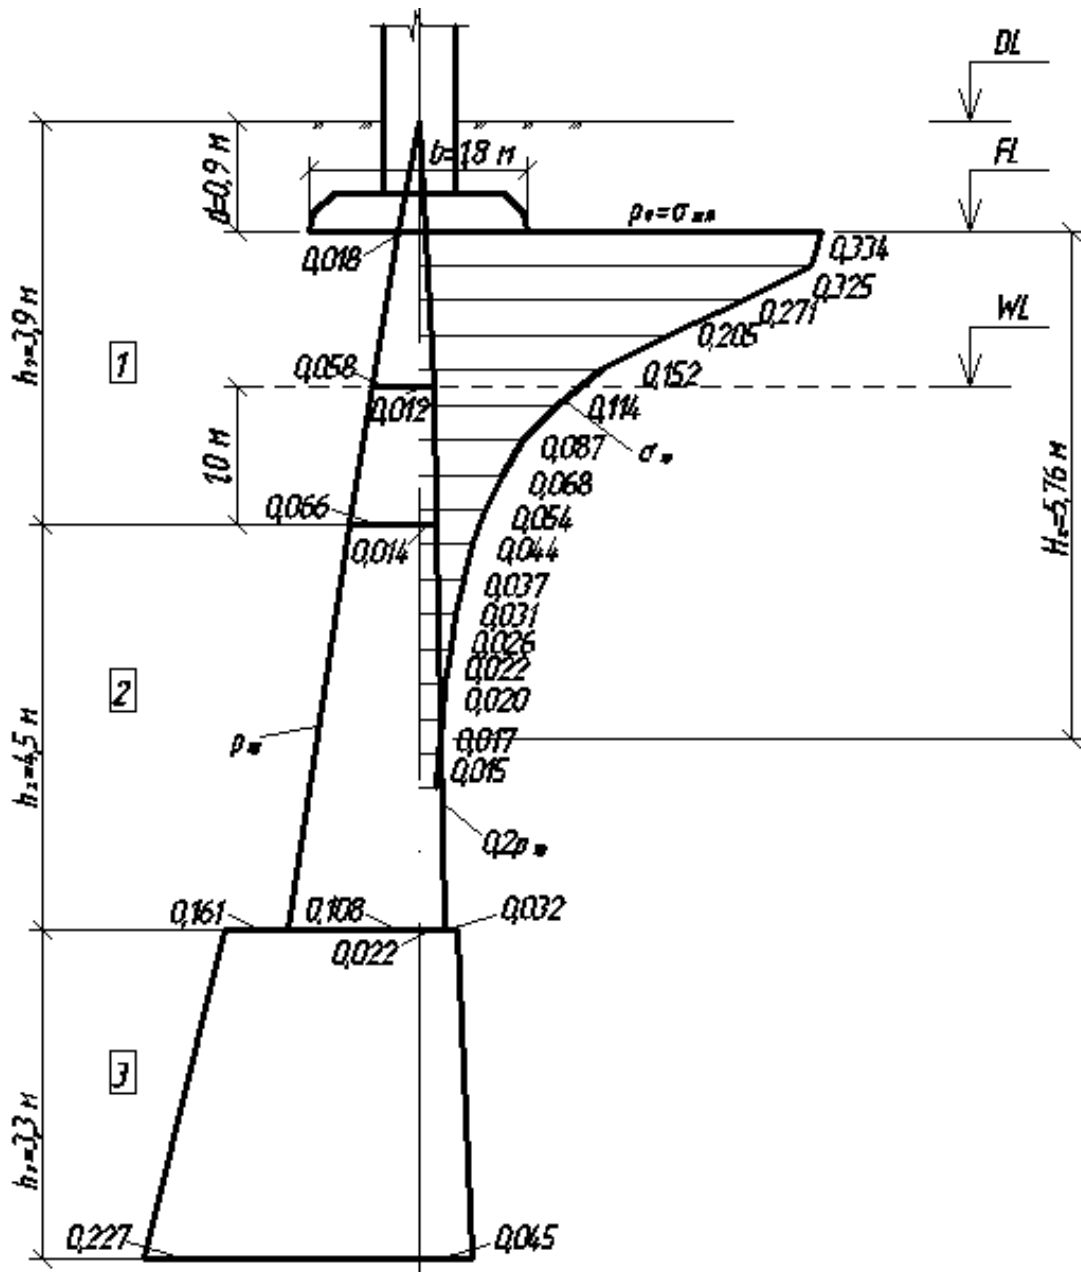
Расчетная схема основания фундамента к примеру 3
